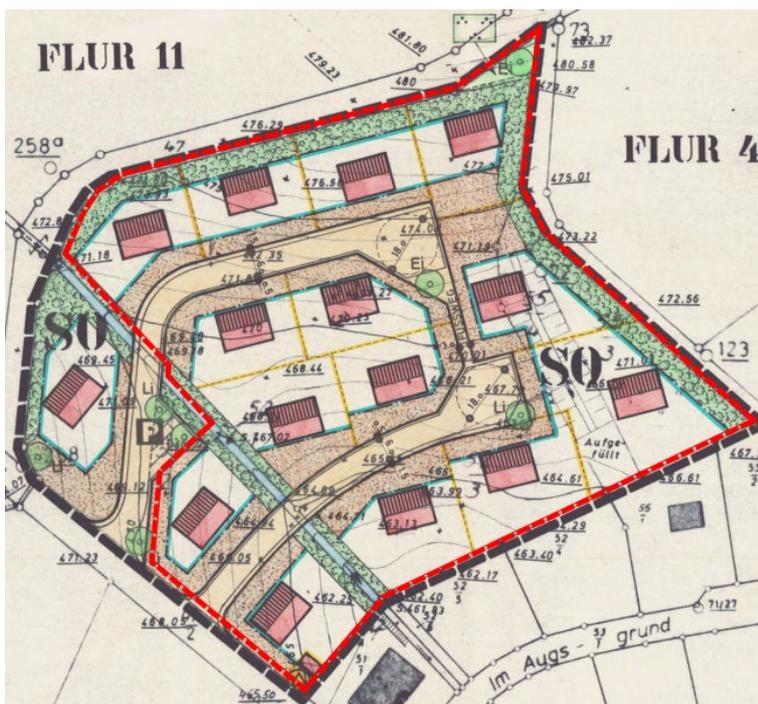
Geltungsbereich B-Plan Nr. 4 „Im Augsgrund“ mit Darstellung des Änderungsbereiches
